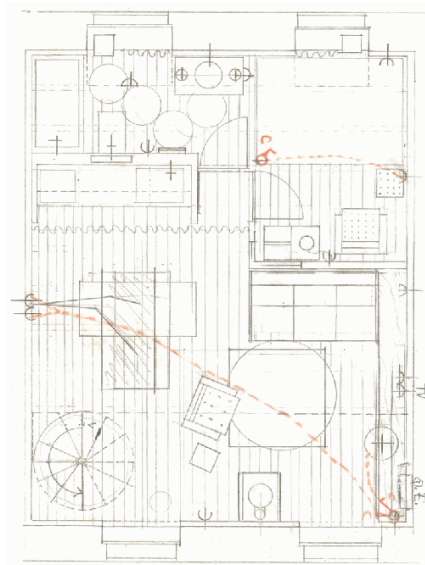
Bairro Ignez, Casa 6, Porto - Planta
